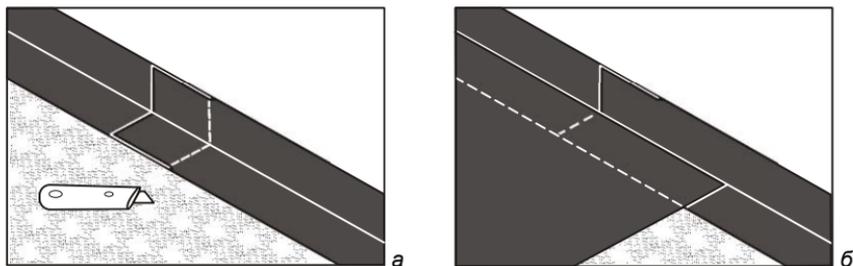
Этапы монтажа гидроизоляционного покрытия «MustaPekka»
